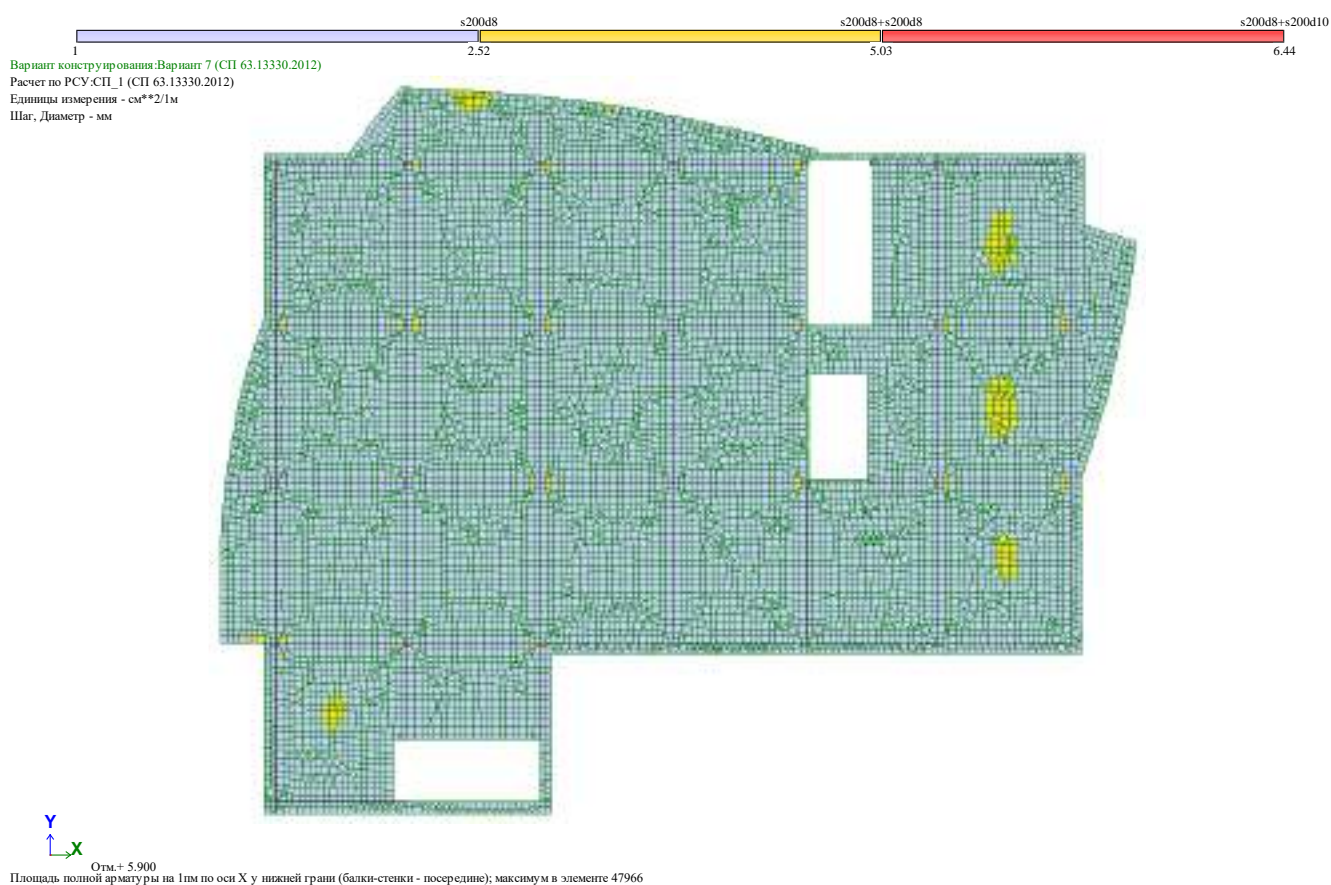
Мозаика армирования нижней арматуры вдоль б.о.
